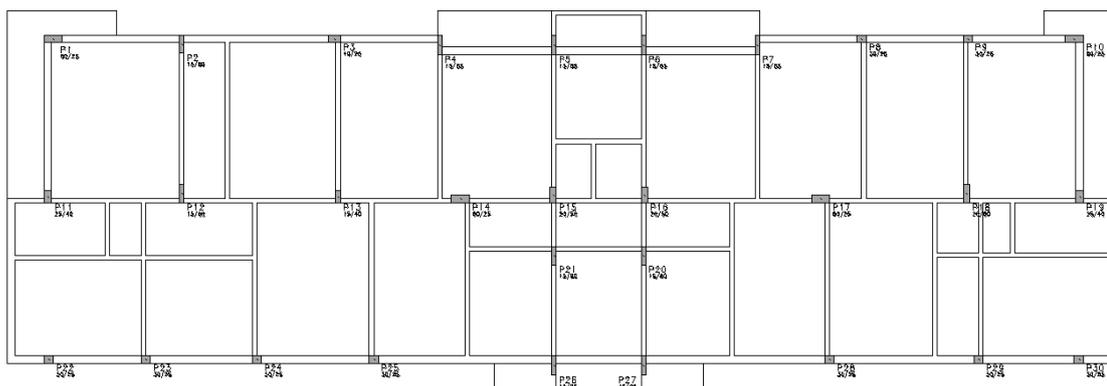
Planta de fôrma do pavimento tipo do Modelo ORIG-8PAV
